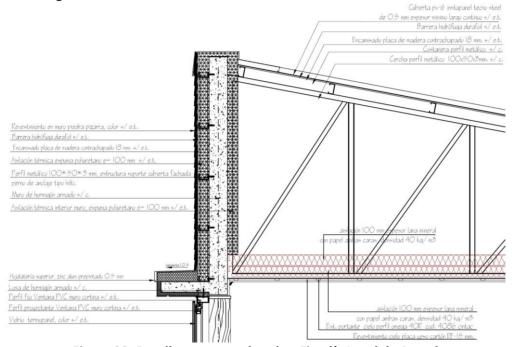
Detalle muro y techumbre Fiscalía Local de Ancud.
